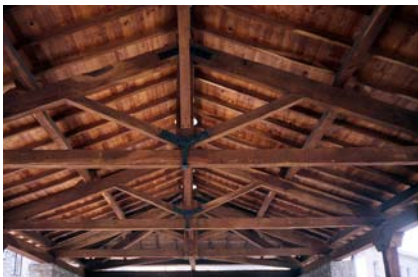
Armadura de cubierta de correas apoyada en cerchas de madera.
